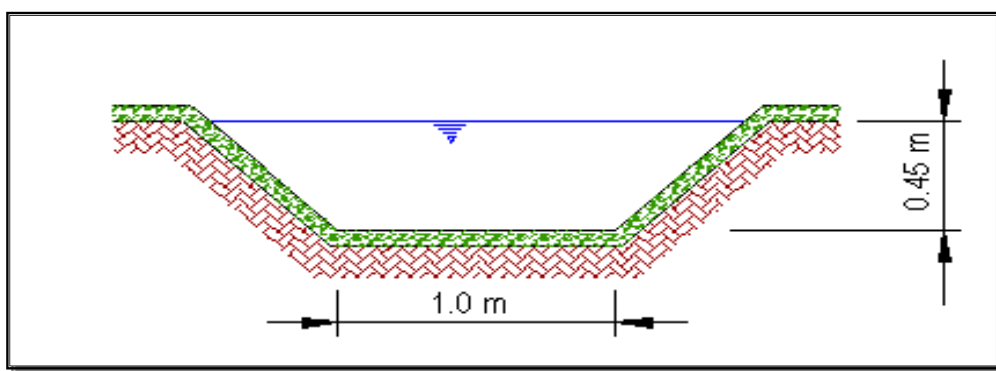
Sección recomendada para la reconformación y rectificación del cauce. Fuente: Plan maestro de alcantarillado de Tunja 1999
